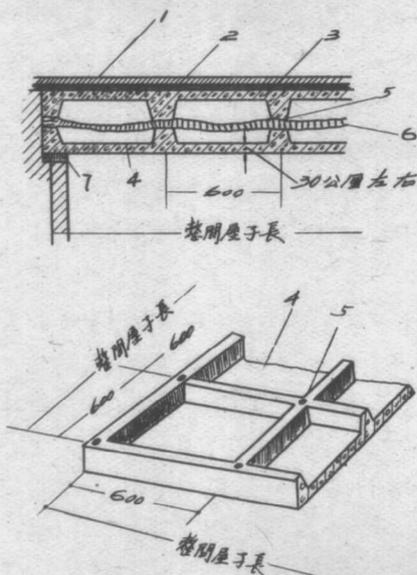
鋼筋混凝土大型板材樓板層(米哈伊洛夫教授提供)
